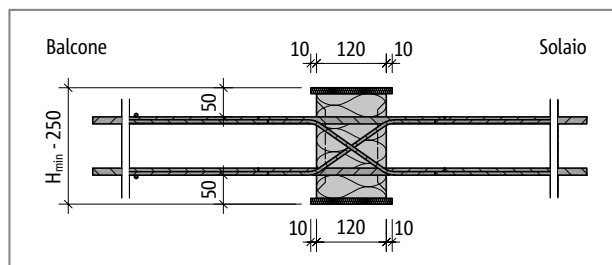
Schöck Isokorb® tipo DXT-CV50, REI120: sezione dell'elemento
